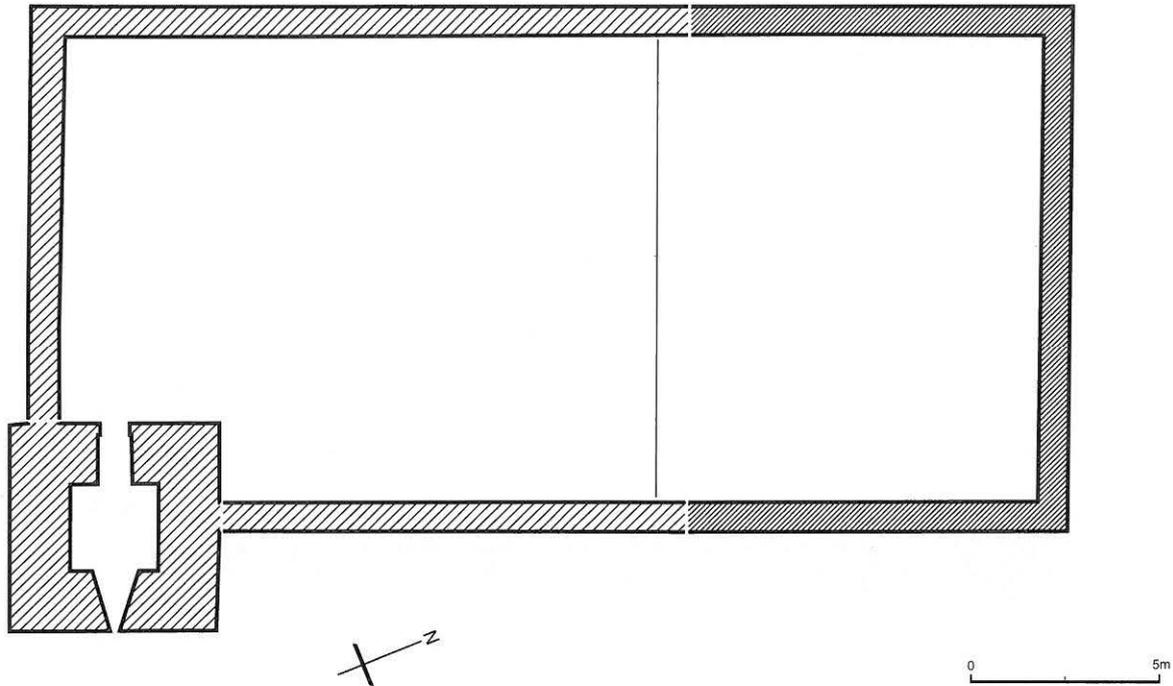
Grundriss der vierten Anlage von 1841, 1852 wieder aufgebaut. M. 1:200.
